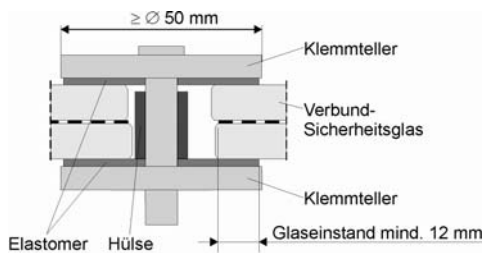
Prinzipskizze Querschnitt Tellerhalter
